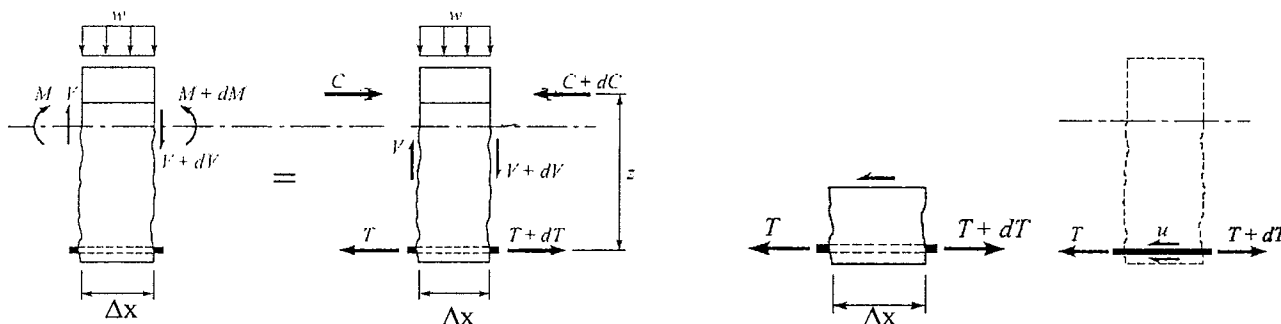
Equilibrio de un elemento entre grietas.
